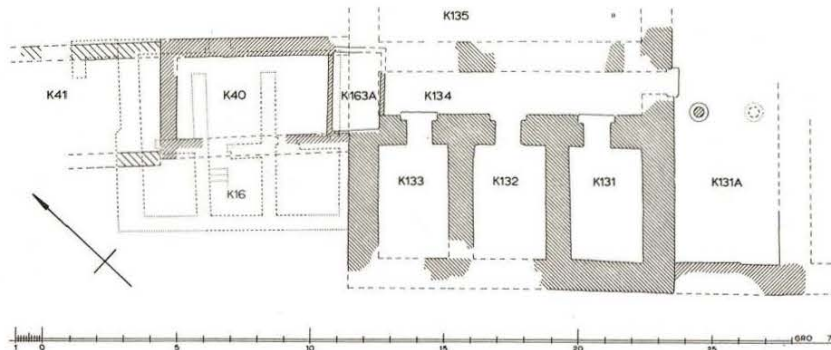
Bau K 13 mit Anschlußbauten nach Westen.
